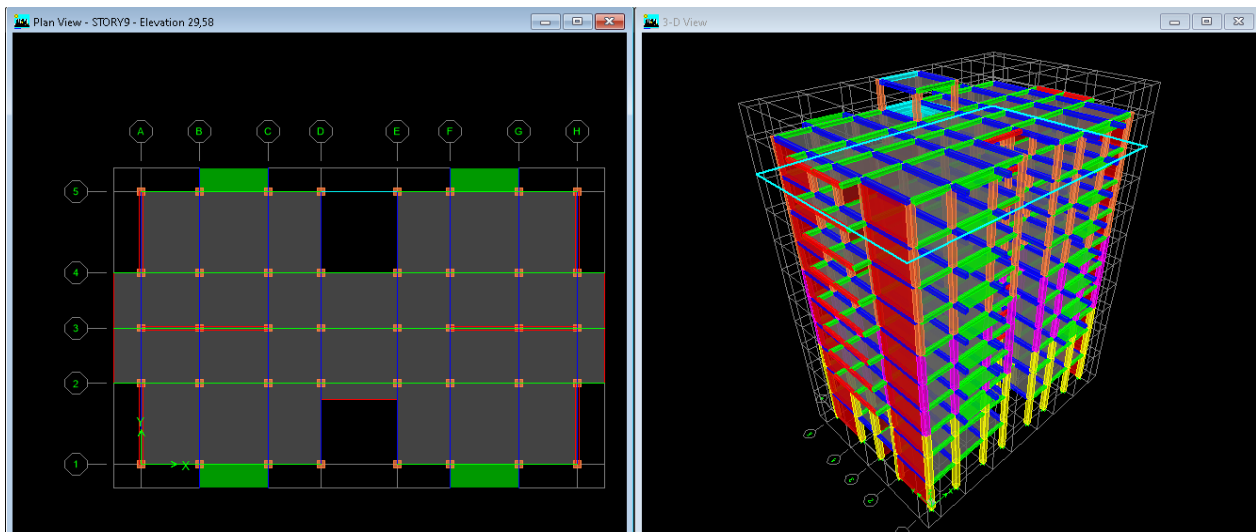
Vue en plan des éléments structuraux d'un étage.
